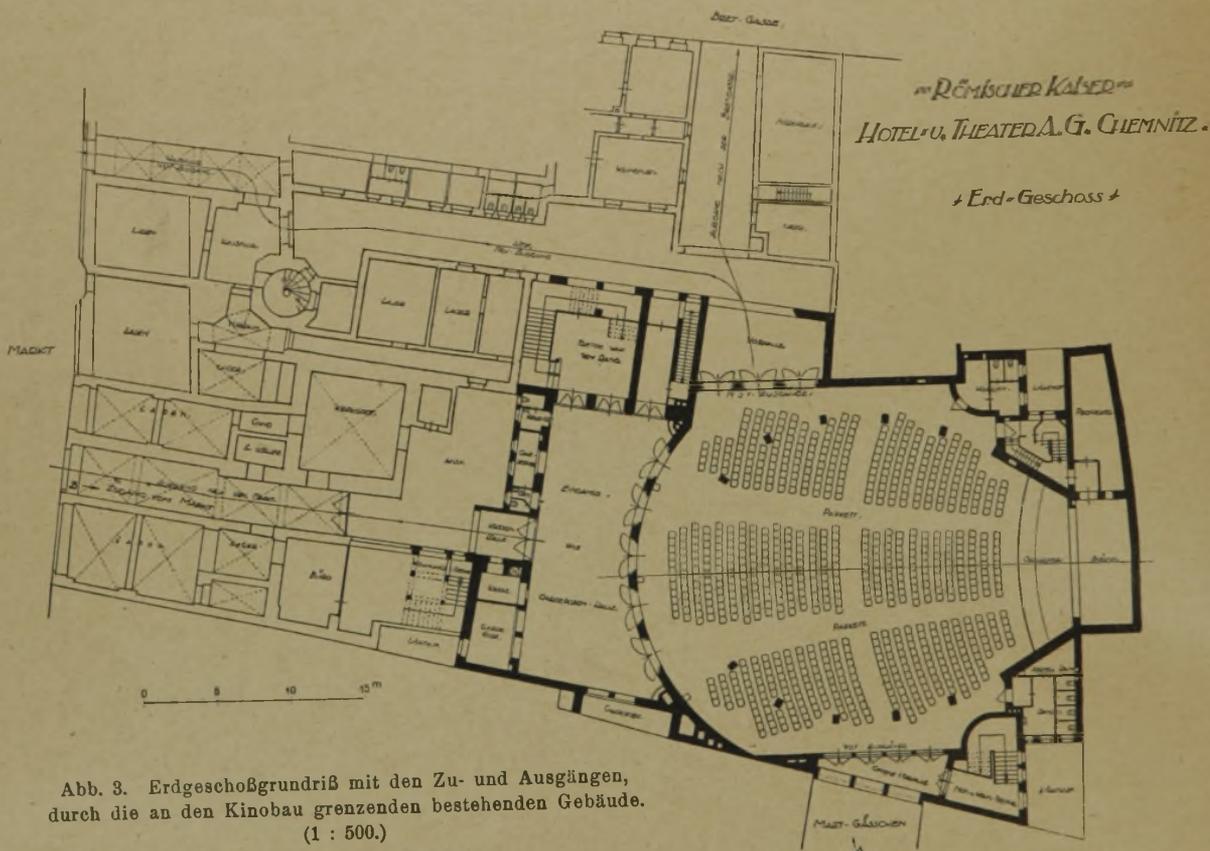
Erdgeschoßgrundriß mit den Zu- und Ausgängen, durch die an den Kinobau grenzenden bestehenden Gebäude. (1 : 500.)
